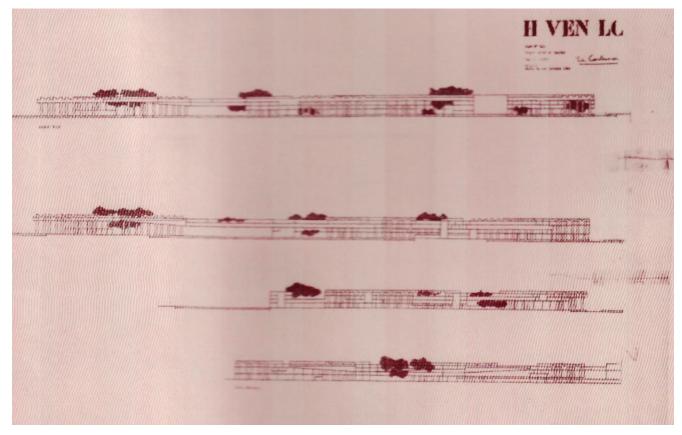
Alzados originales sacados del archivo de la biblioteca sobre el proyecto del Hospital de Venecia.
